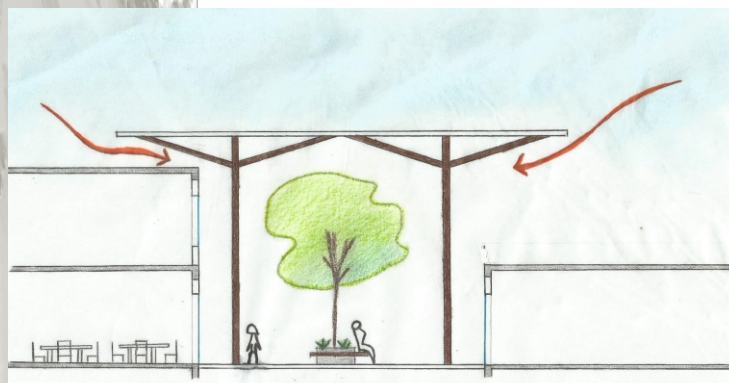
Corte esquemático do eixo permeável com estrutura da cobertura em madeira
